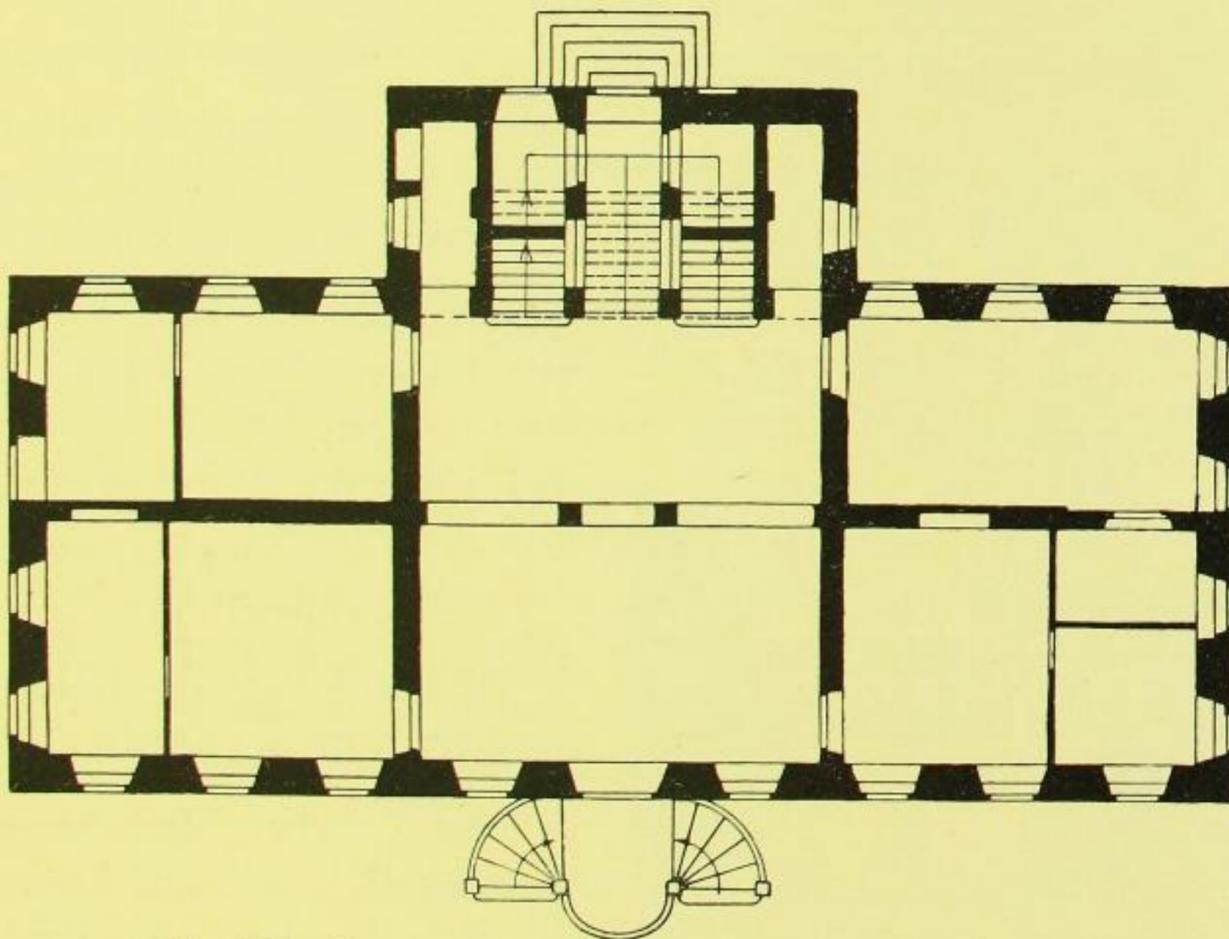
Strauch, Rittergut, Grundriß des Erdgeschosses.
